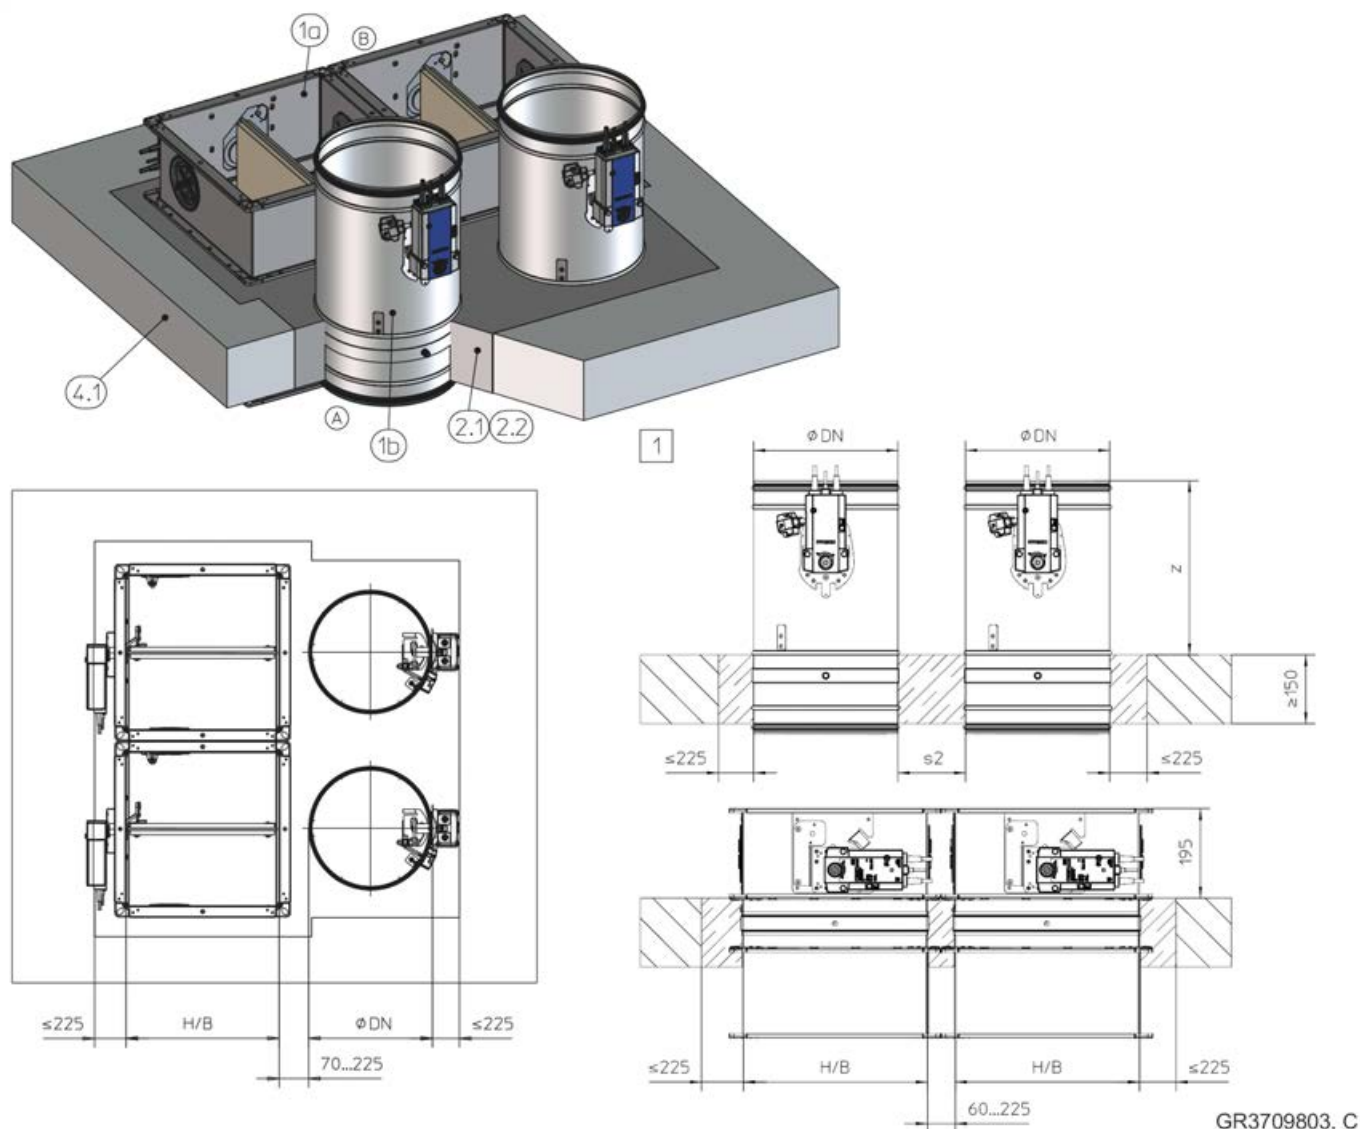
Installazione in muratura in un soffitto a soletta piena, FK2-EU e FKR-EU combinate, l'illustrazione mostra l'installazione verticale (vale anche per l'installazione sospesa)
